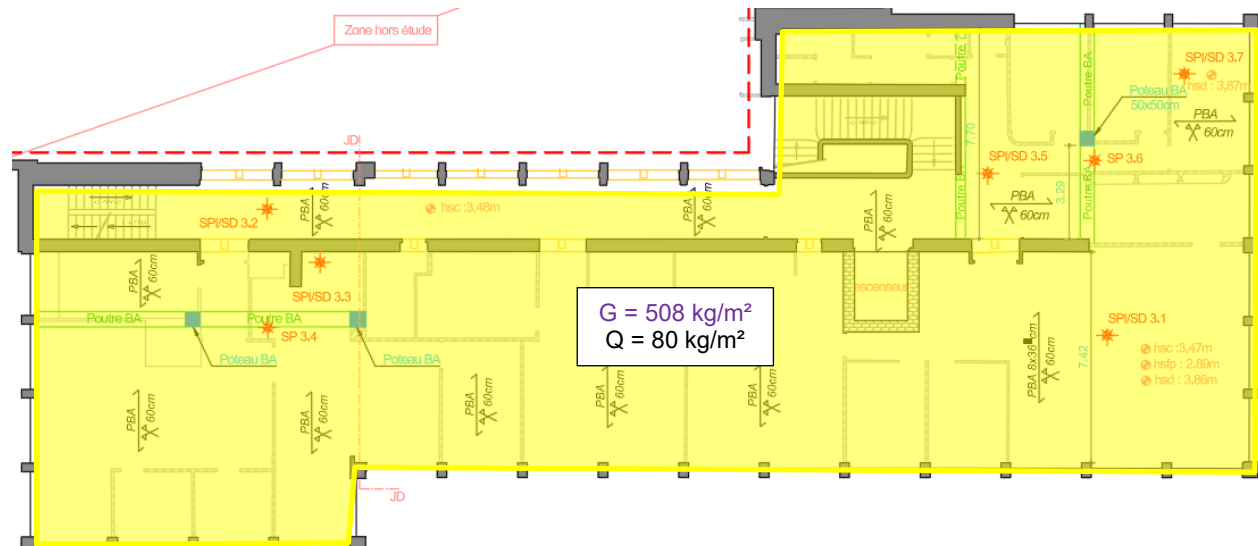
Charges considérées PH R+2 (hors poids propre béton armé)
